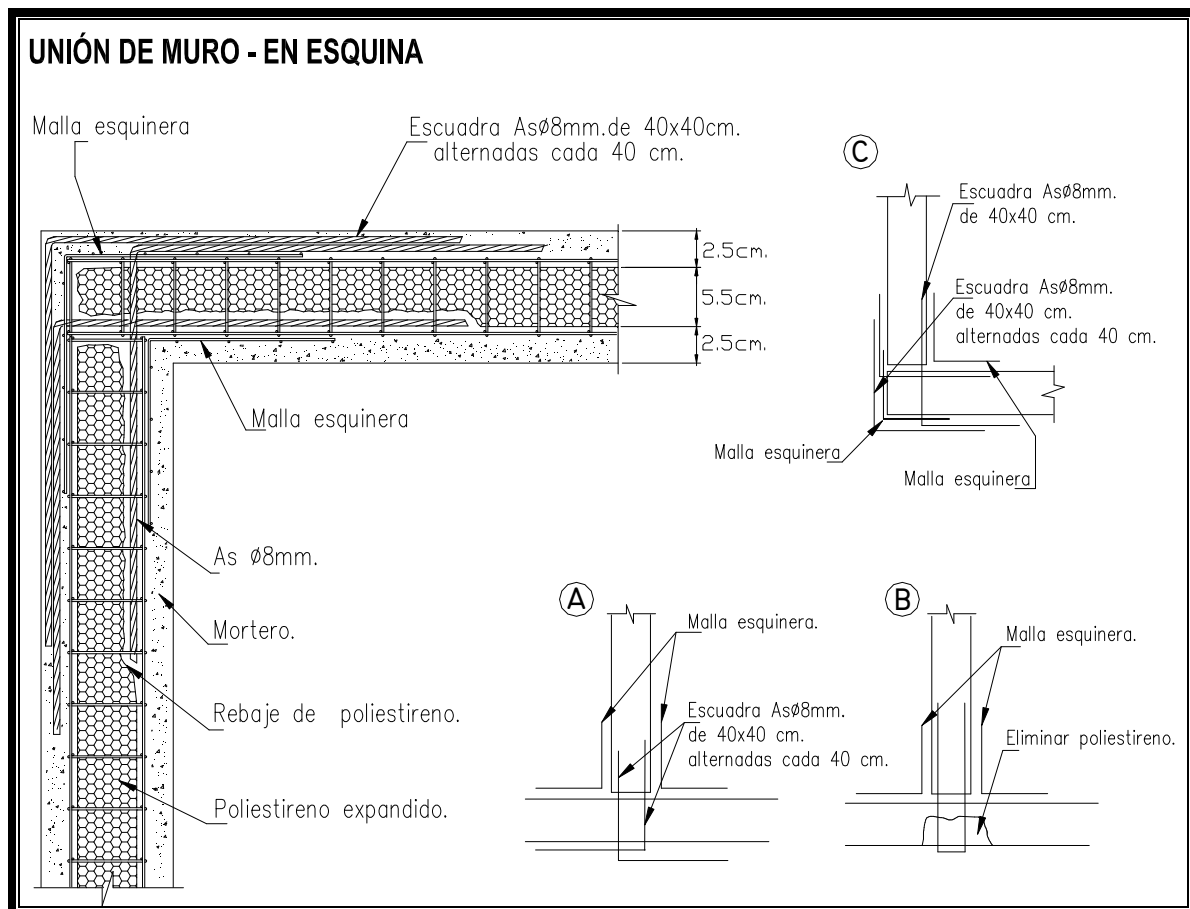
Detalle de colocación de acero de refuerzo en la unión de muros en esquinas
